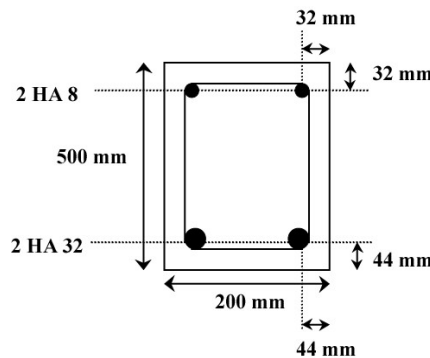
Distribution des aciers dans la poutre. Section transversale
